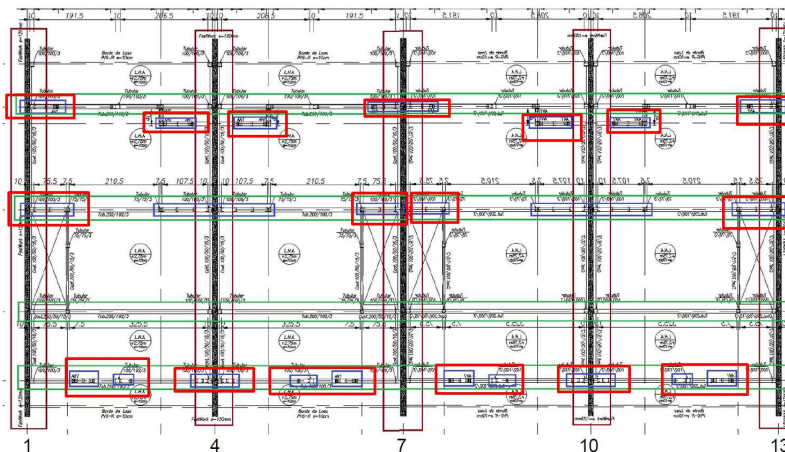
Planta con ubicación de tabiques Metalcon.
